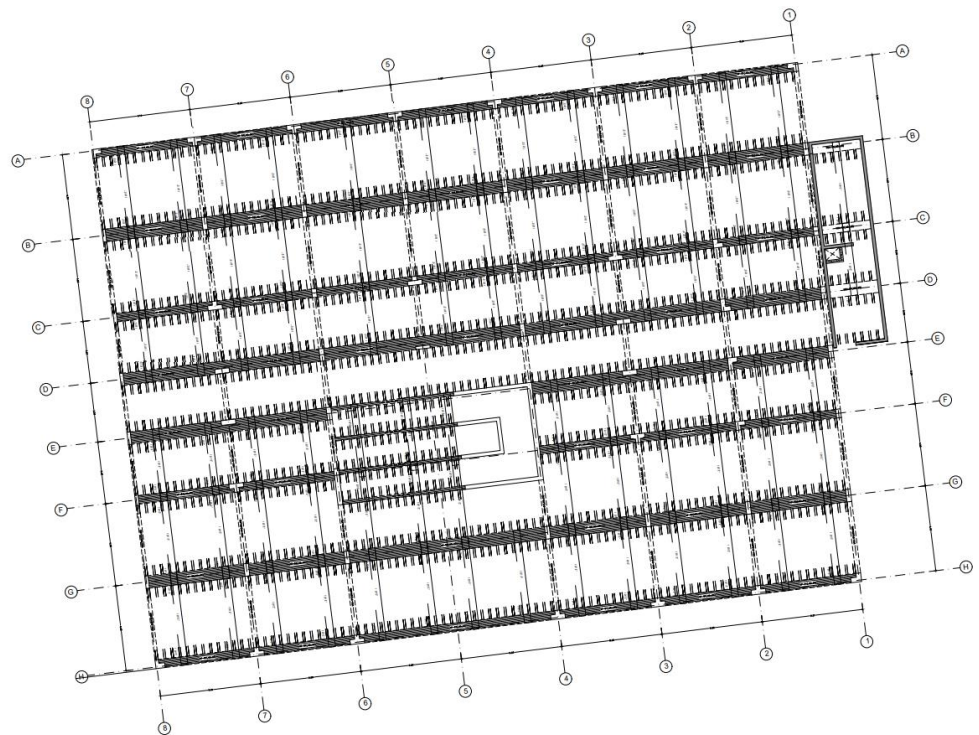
Aligerado Primer, Segundo y Tercer Nivel – Habitación Mujeres
